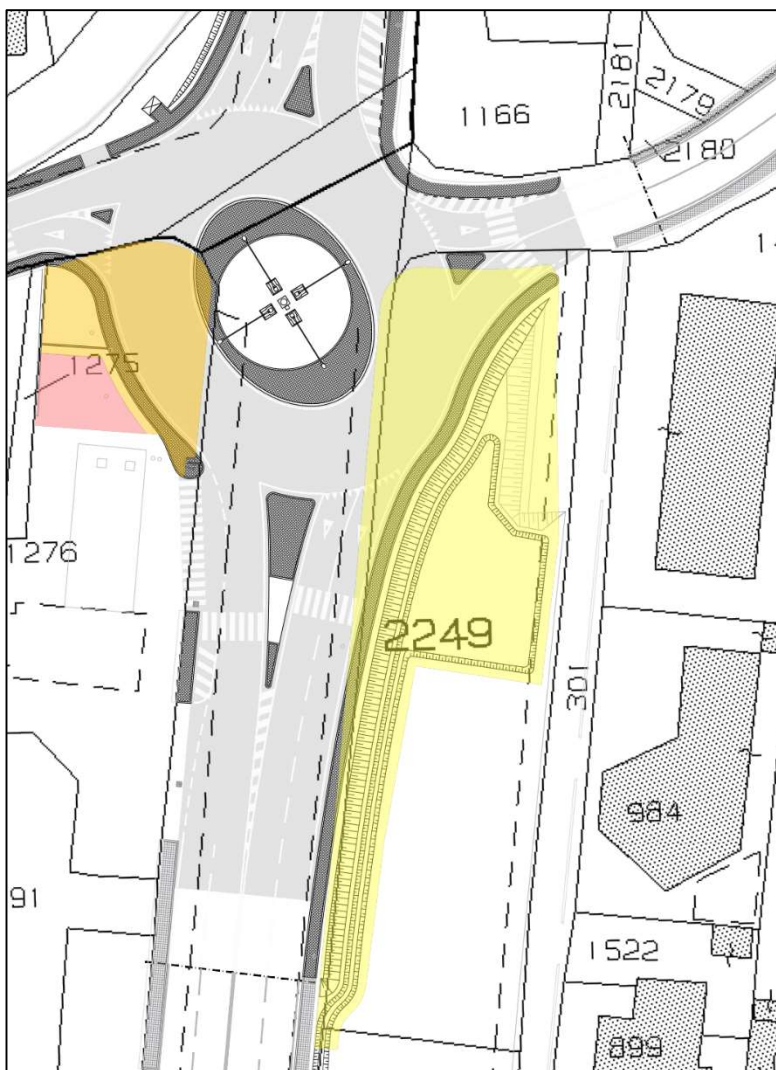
Stralcio planimetrico incrocio tra Viale Europa e Via delle Fornacette
